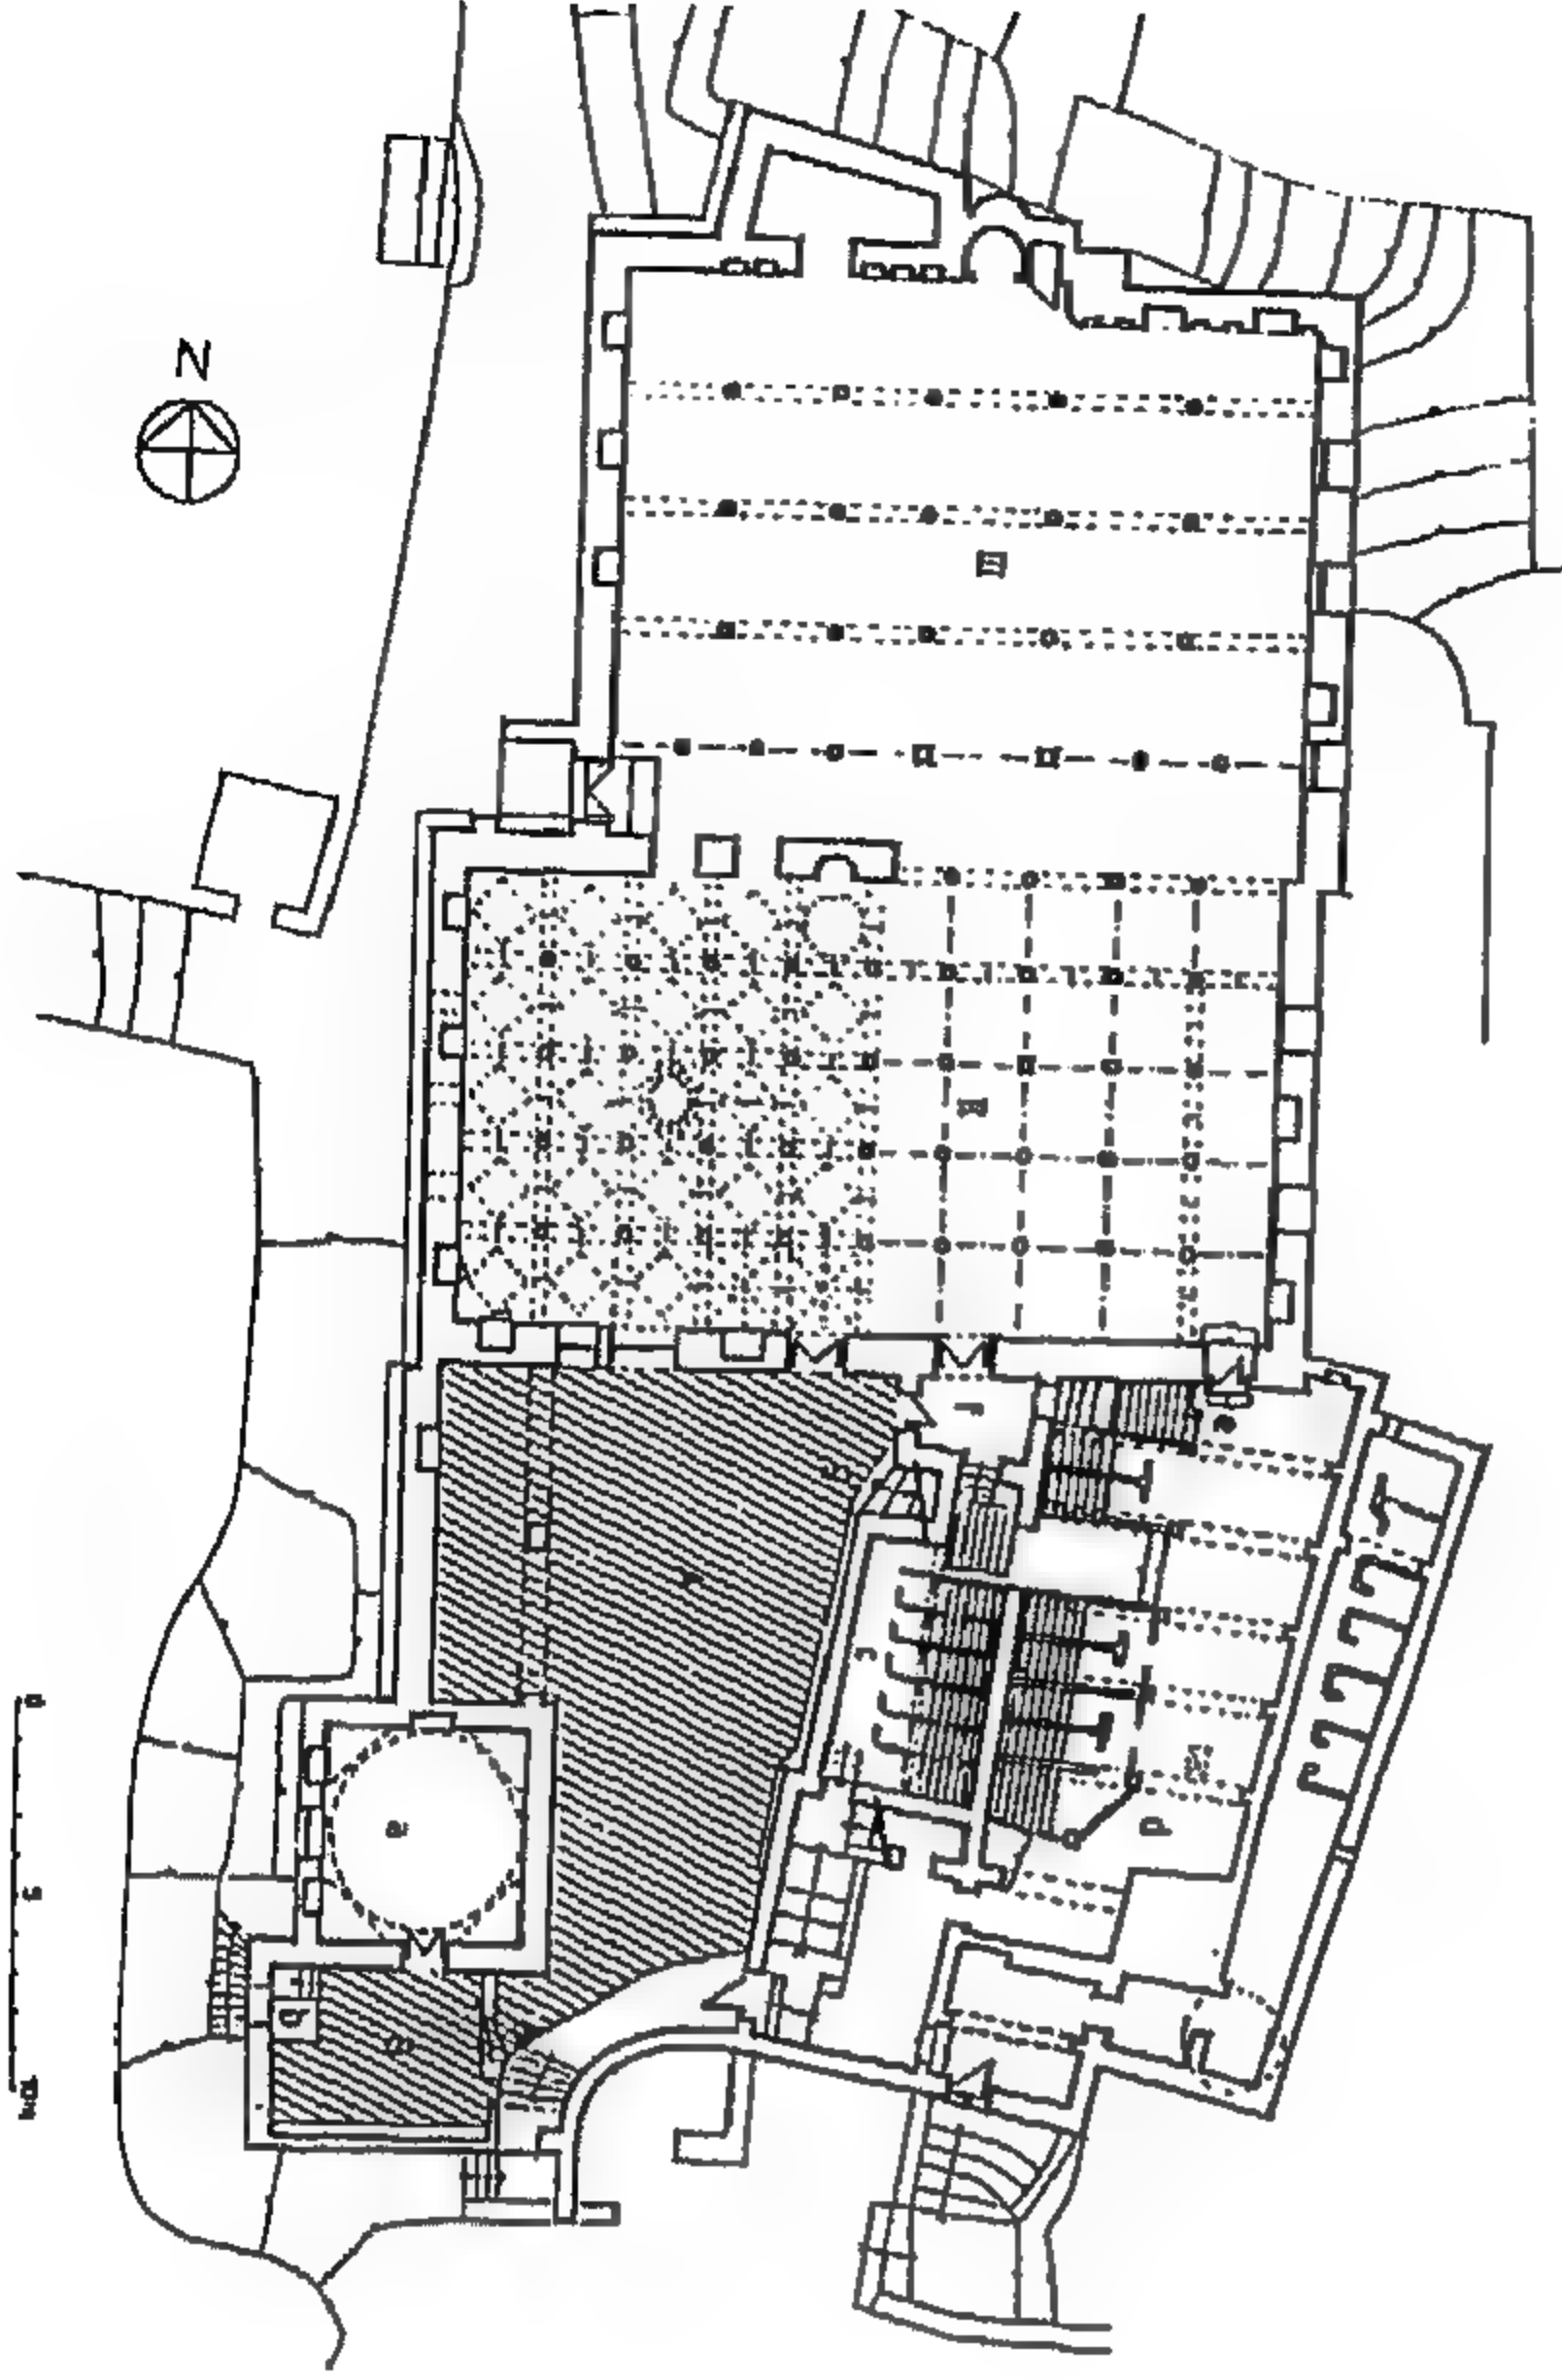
ج) مسقط أفقي يبين المرحلة الثالثة للجامع الكبير (عمل الباحث)
